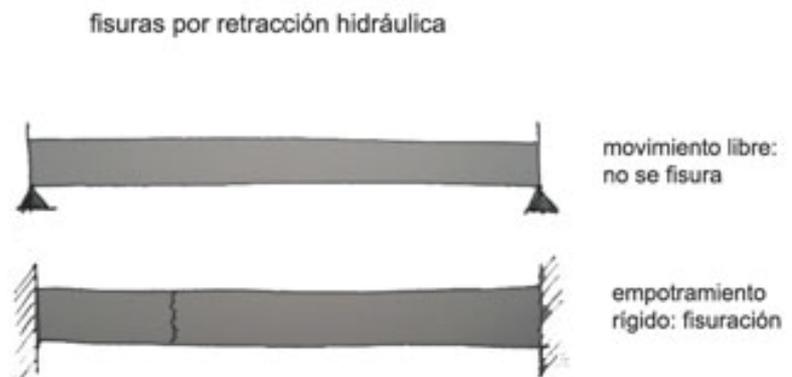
Fisuras por retracción hidráulica en elementos restringidos
